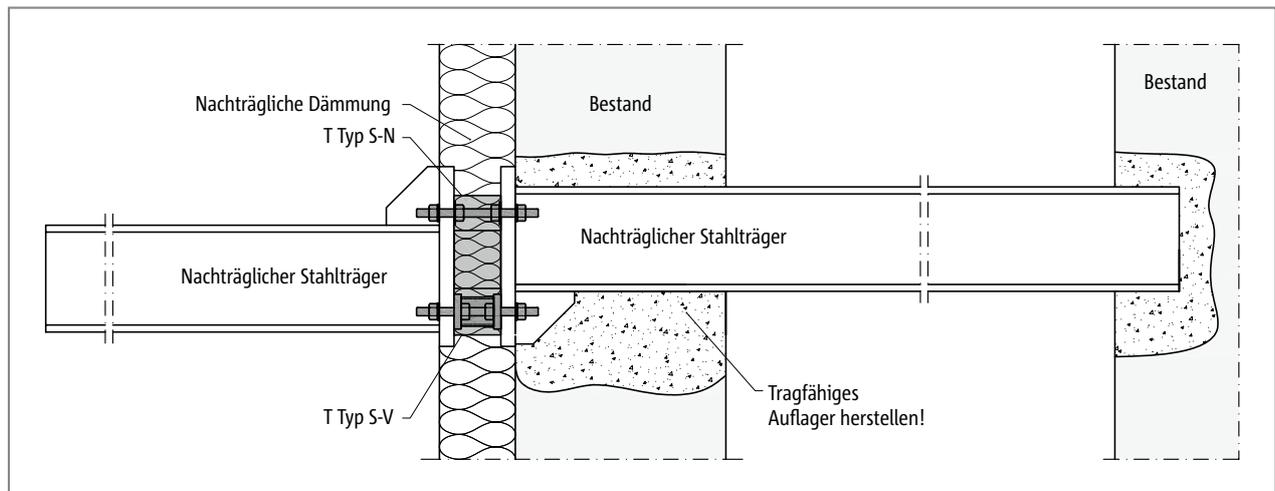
Schöck Isokorb® T Typ S-N und T Typ S-V: Nachträglicher Stahlbalkon frei auskragend; angeschlossen mit Höhenversatz an nachträglich eingebauten Stahlträger
